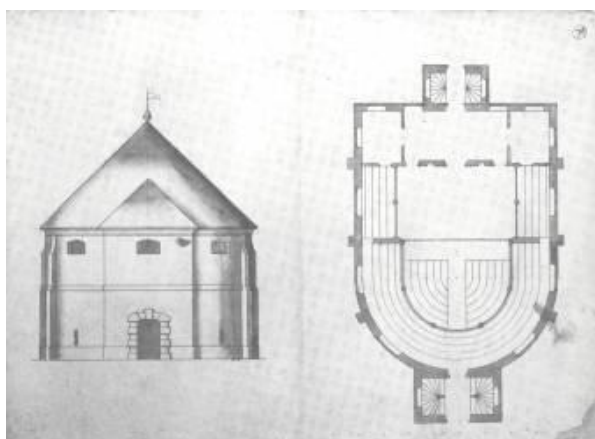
Alçado e planta do teatro de Inigo Jones em Drury Lane, Londres
